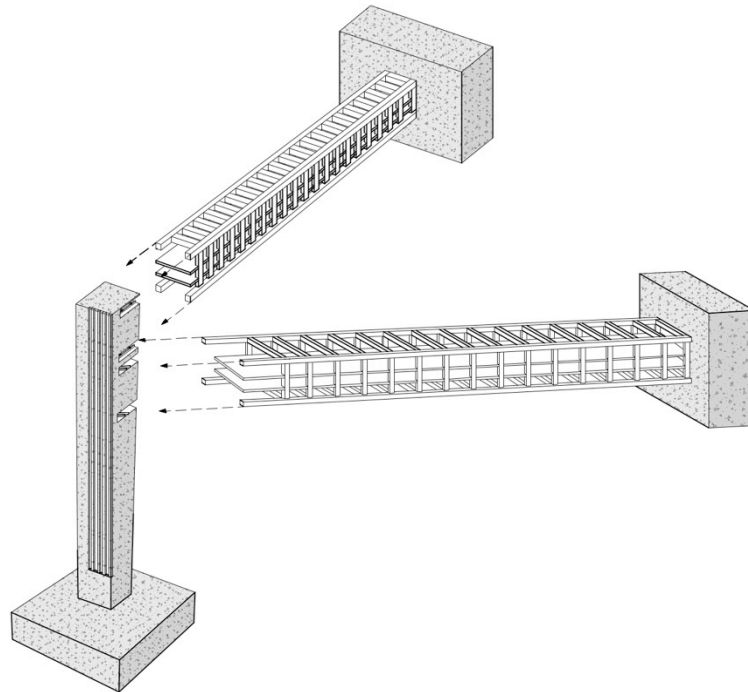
Perspetiva esquemática dos encastramentos do pilar e das vigas
